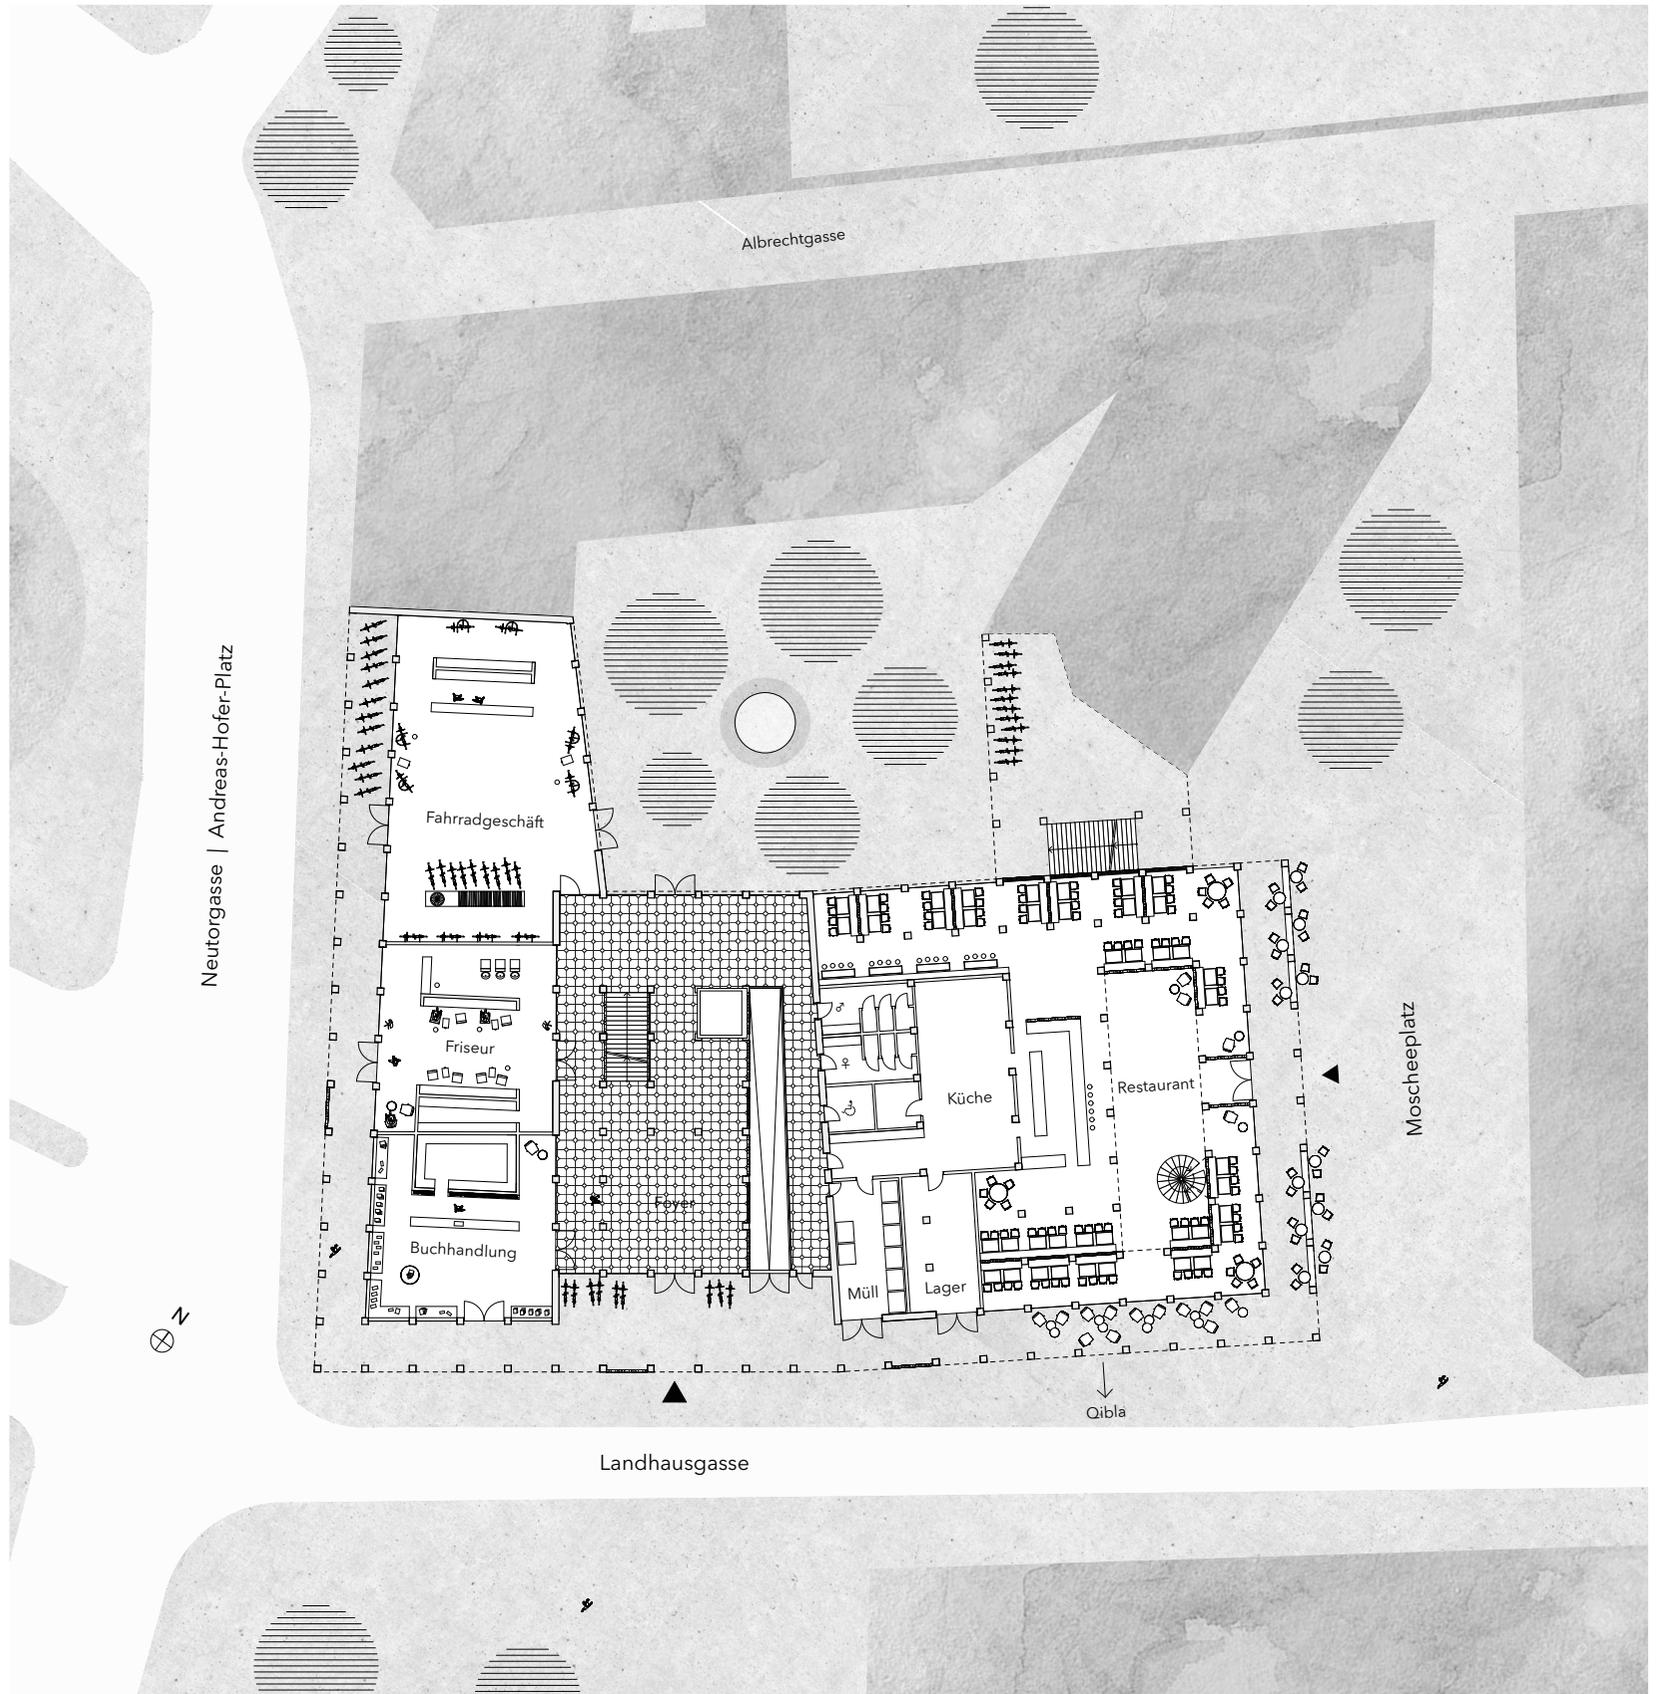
Grundriss Ebene 0 | 1:500
